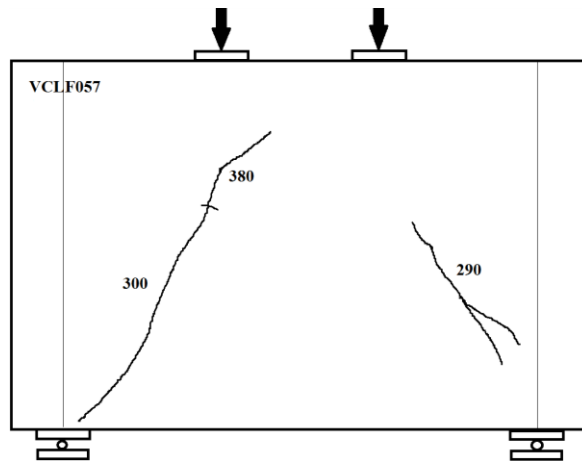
Esquema de fissuração da viga VCLF057.
